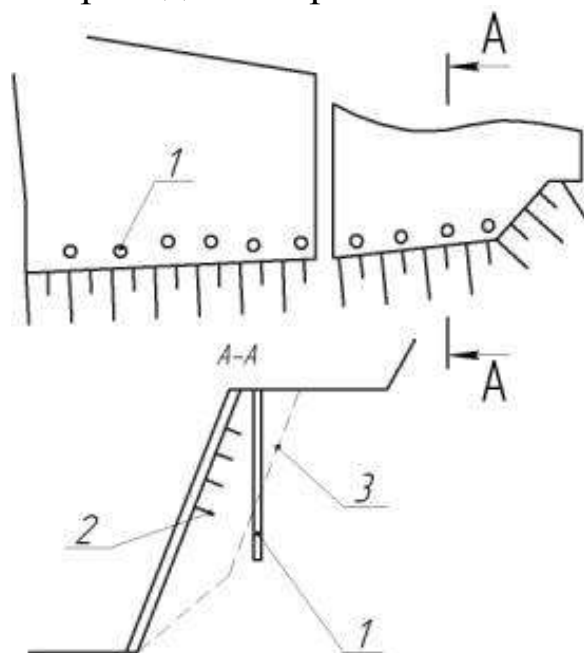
Схема укрепления участка с помощью железобетонных свай набивного типа: 1 – железобетонные сваи; 2 – железобетонные штанги; 3 – расчётная поверхность скольжения
